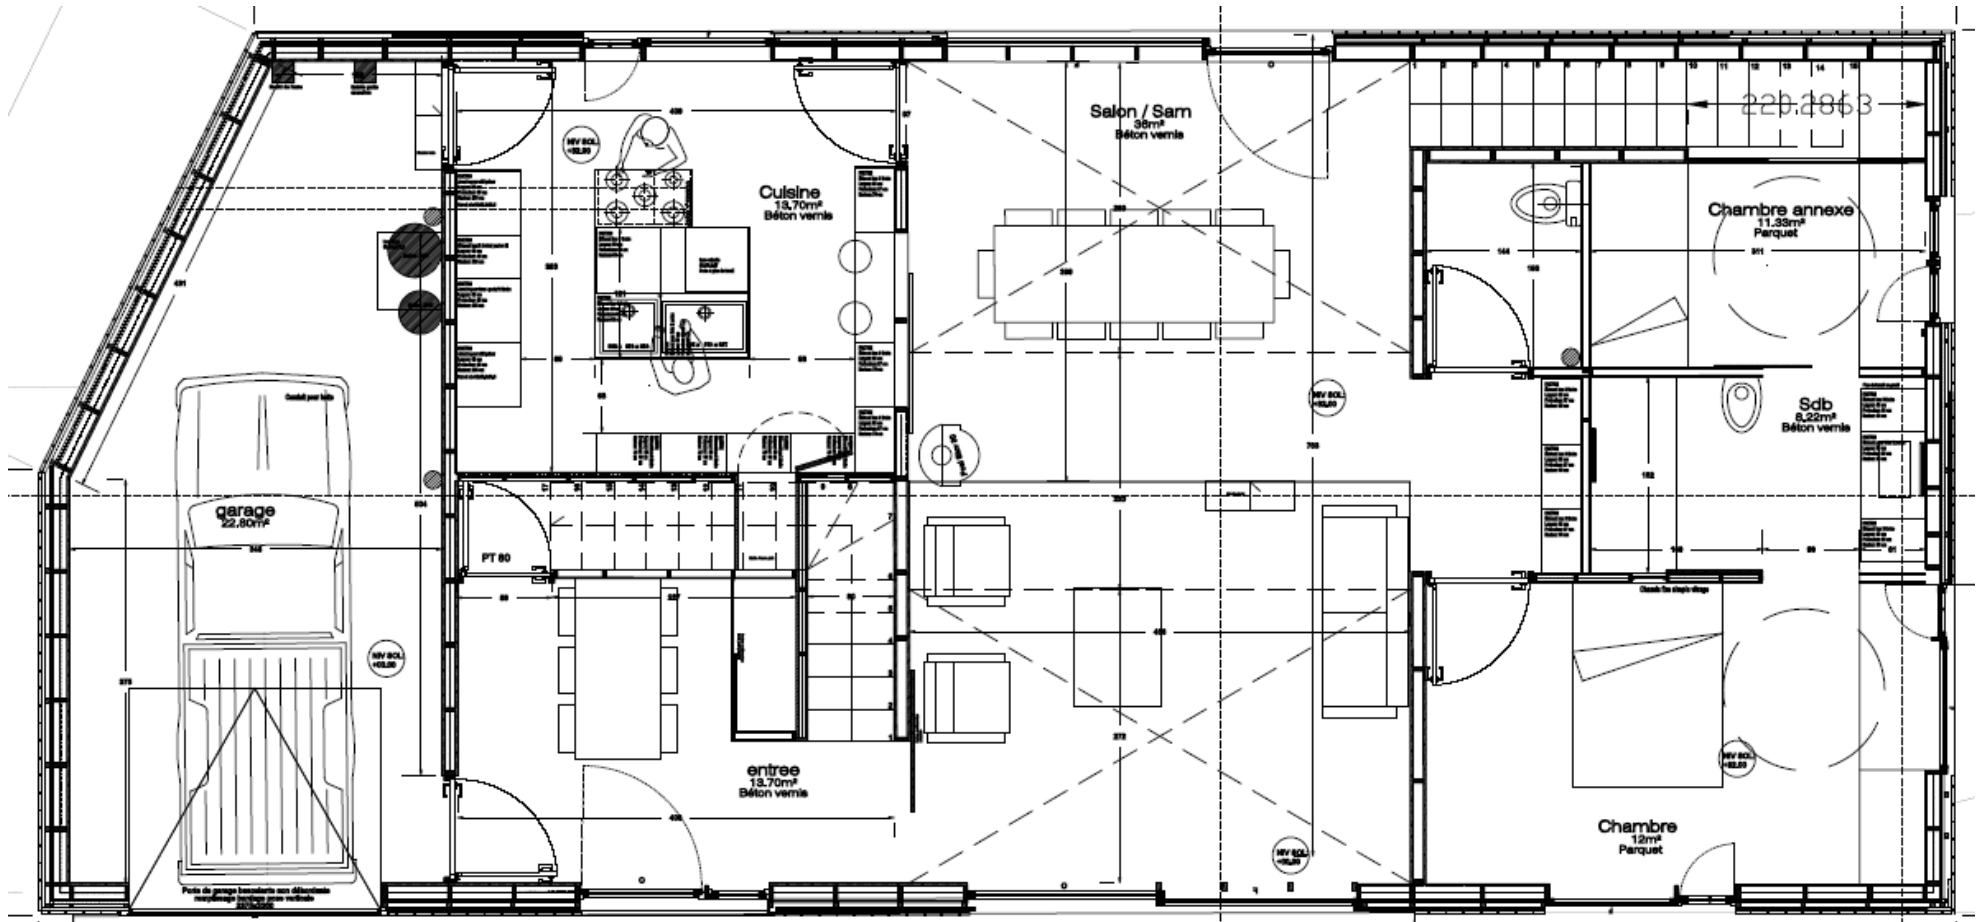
Maison en ossature bois : plan du rez-de-chaussée
